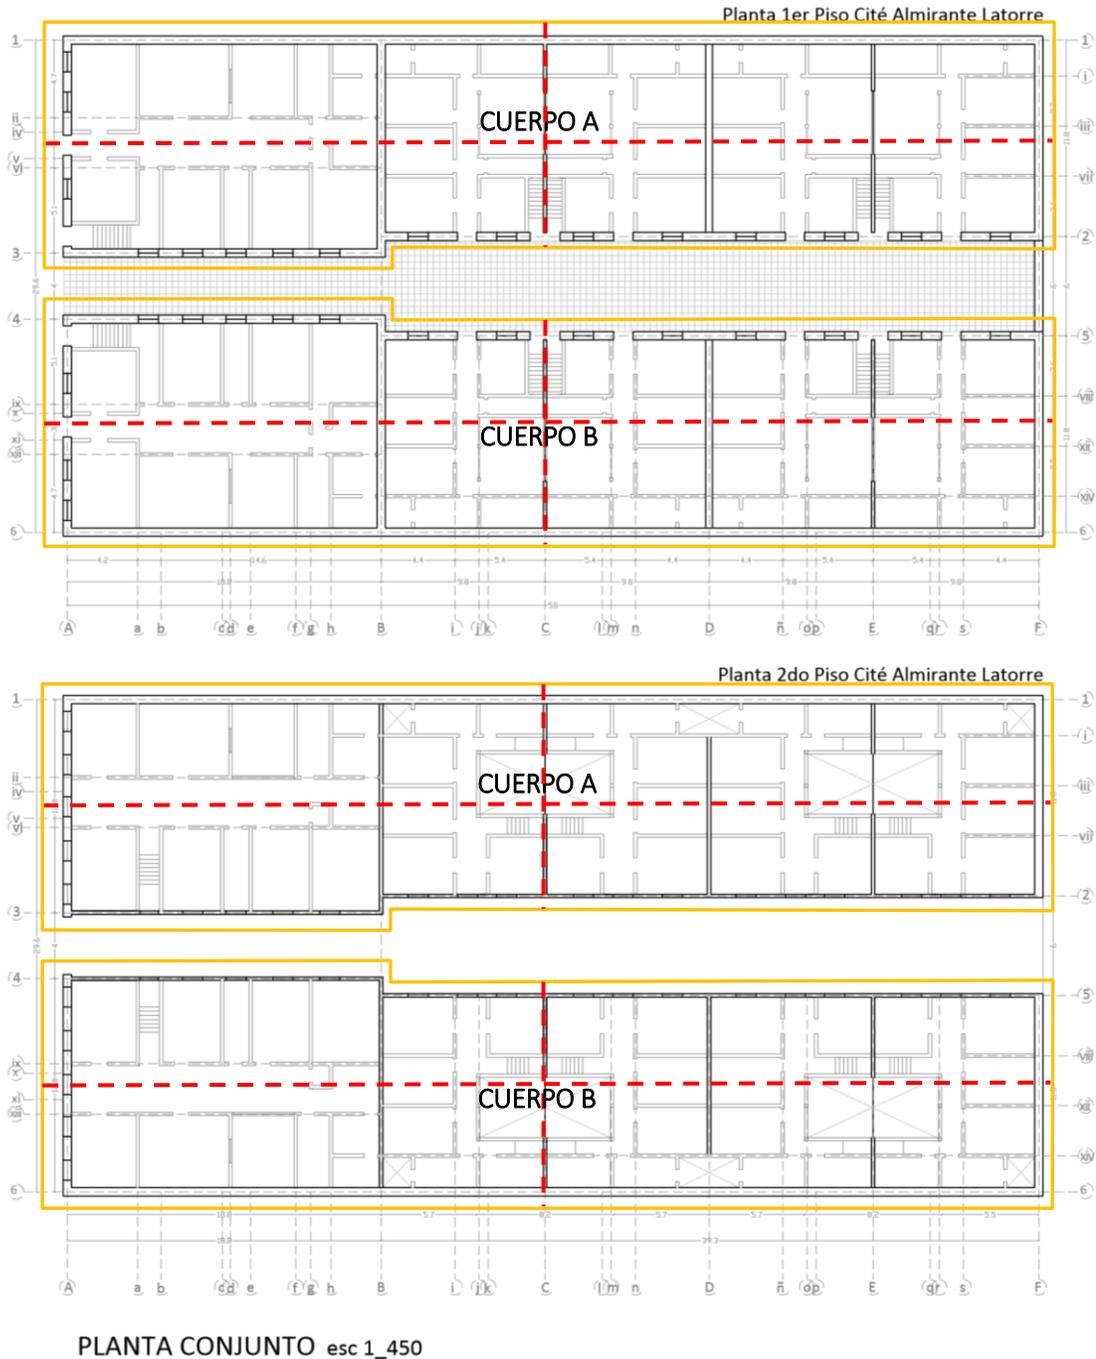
Planta Conjunto ESTRUCTURA Eje ROJO: Ejes de simetría horizontal y vertical.
